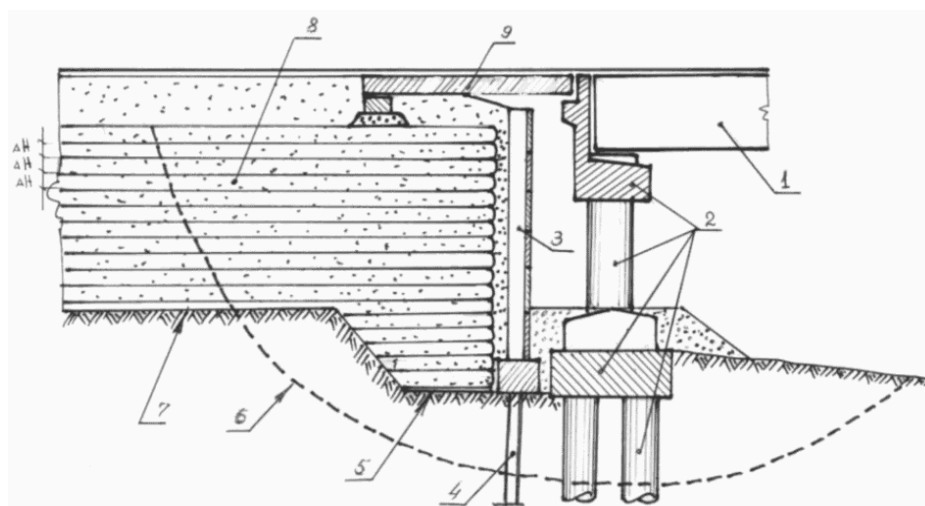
Многофункциональные армогрунтовые системы мостов и путепроводов: 1 – пролетное строение; 2 – несущие элементы устоя; 3 – лицевая стенка армогрунтовой системы; 4 – сваи фундамента лицевой стенки; 5 – заглубление армогрунтовой системы для разгрузки ростверка устоя; 6 – опасная поверхность скольжения; 7 – естественная поверхность потенциально оползневого склона; 8 – армогрунтовая система; 9 – переходные плиты [[1], рис В.3 на стр. 46]
